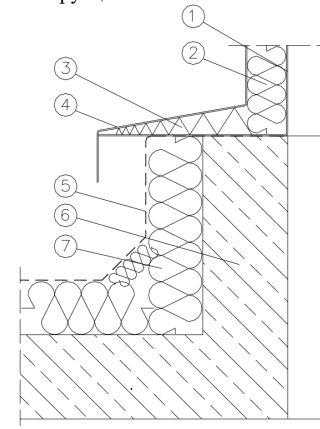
Стальное основание на стальном, деревянном или железобетонном цоколе
